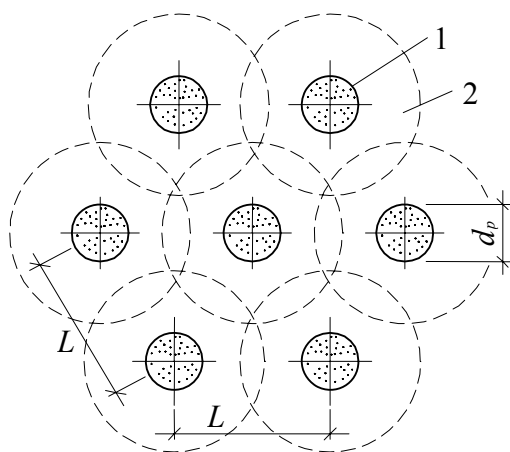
Схема размещения песчаных свай в плане:
